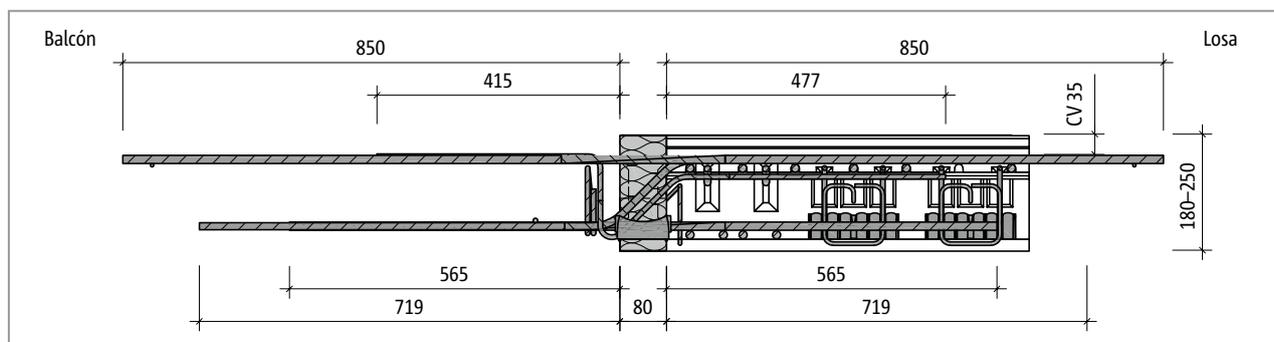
Schöck Isokorb® T tipo C-M3: Sección del producto
